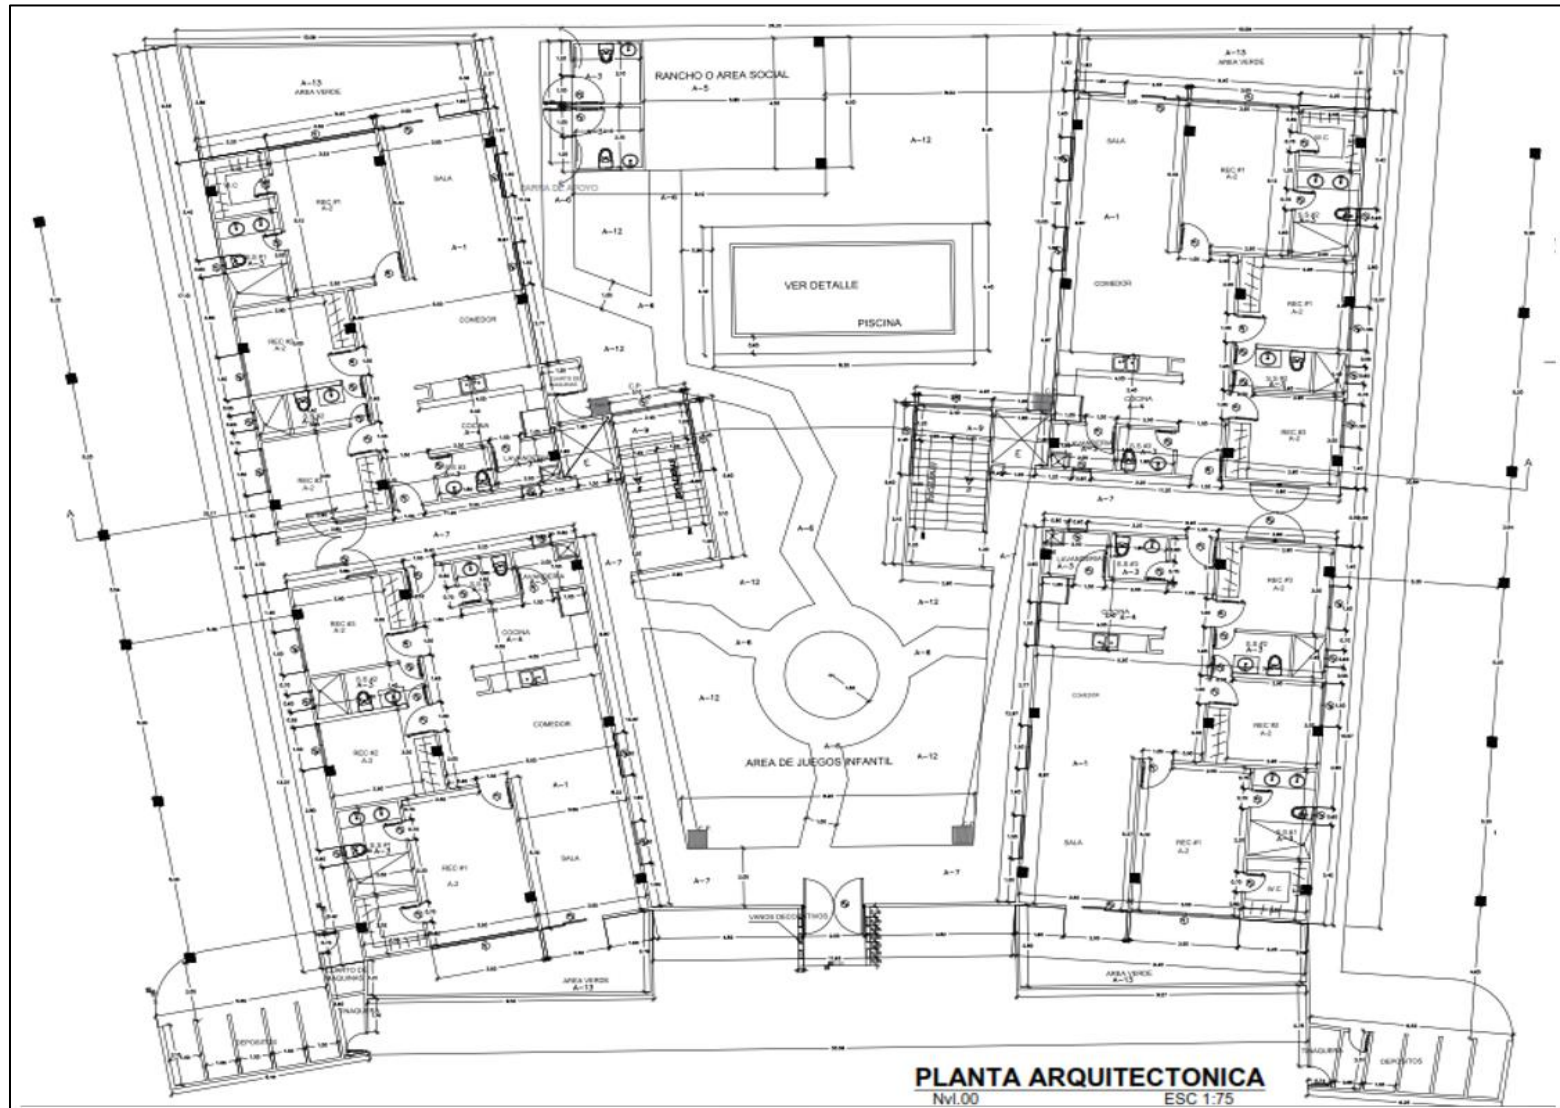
Planta arquitectónica de la Elevación 000. Fuente: Planos de anteproyecto.
